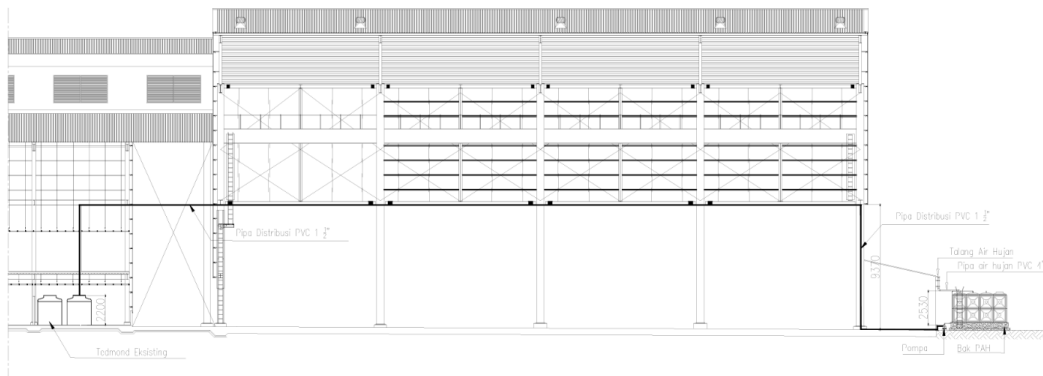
Desain Bak Penampungan Air Hujan Jenis Beton Cor (Data Pribadi, 2025).
